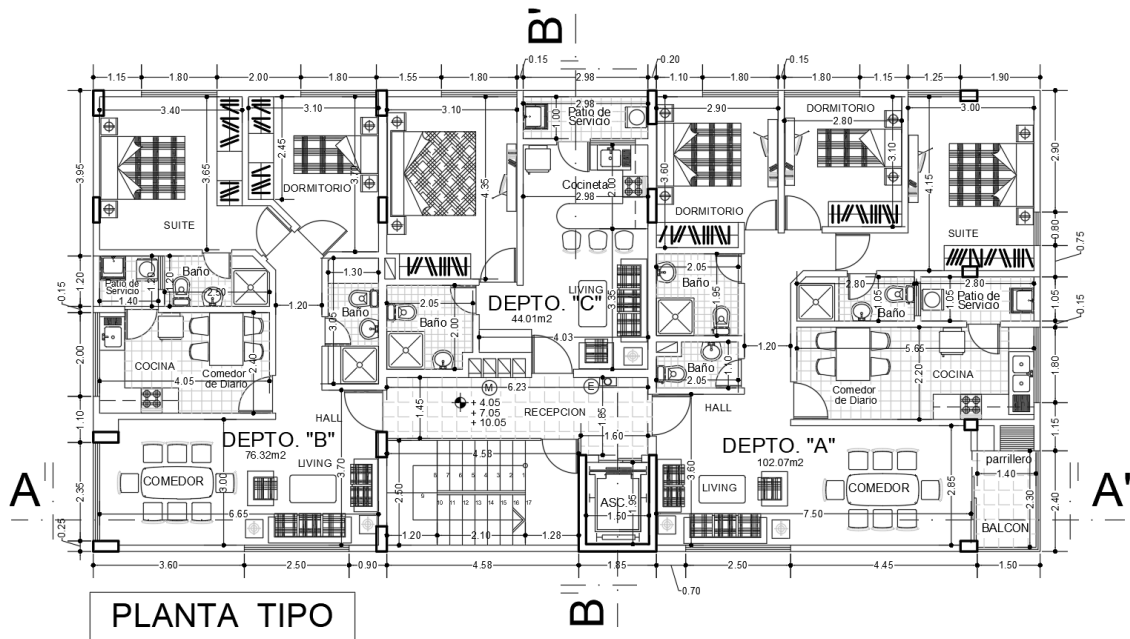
Plano arquitectónico Planta Tipo. [12]
